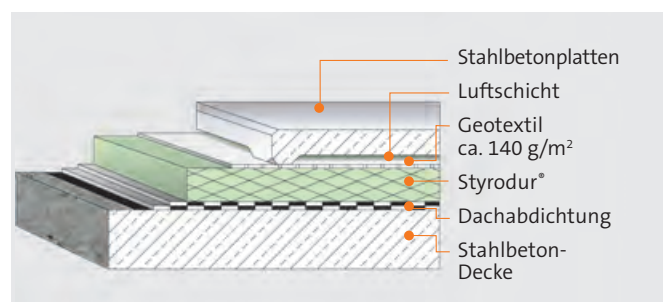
Parkdach mit aufgestellten großformatigen Stahlbetonplatten.
